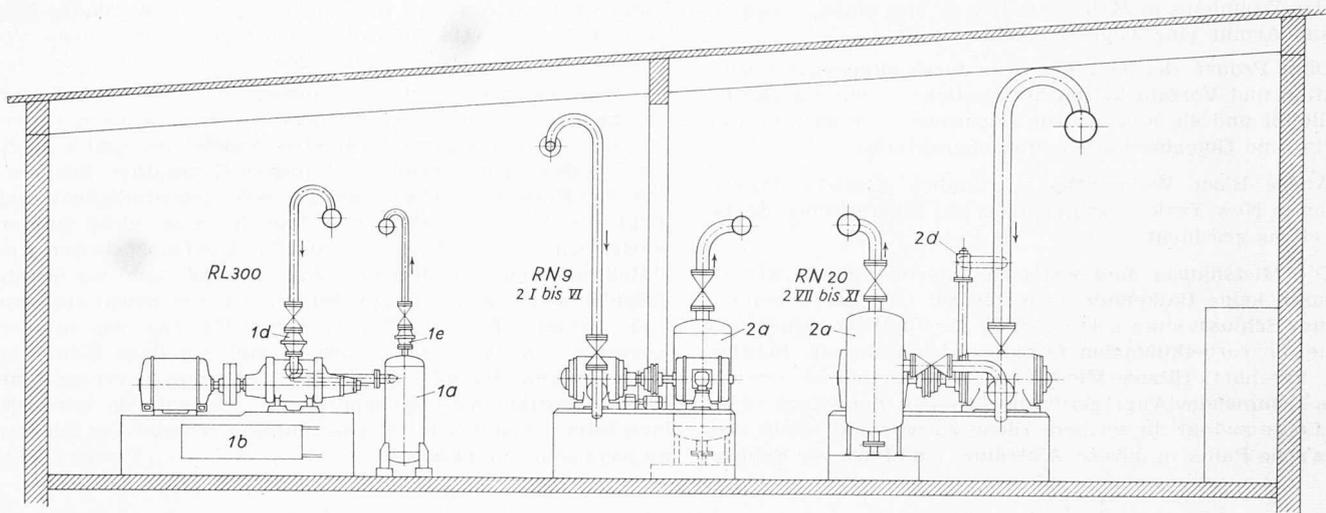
Querschnitt durch den Maschinenraum, 1:100
